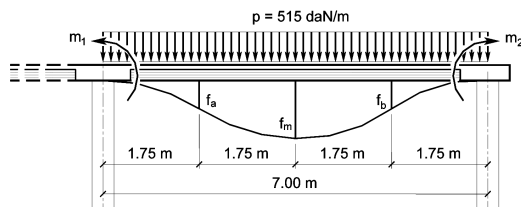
Schema di carico trasversale del solaio. Diagram of transverse floor load.
